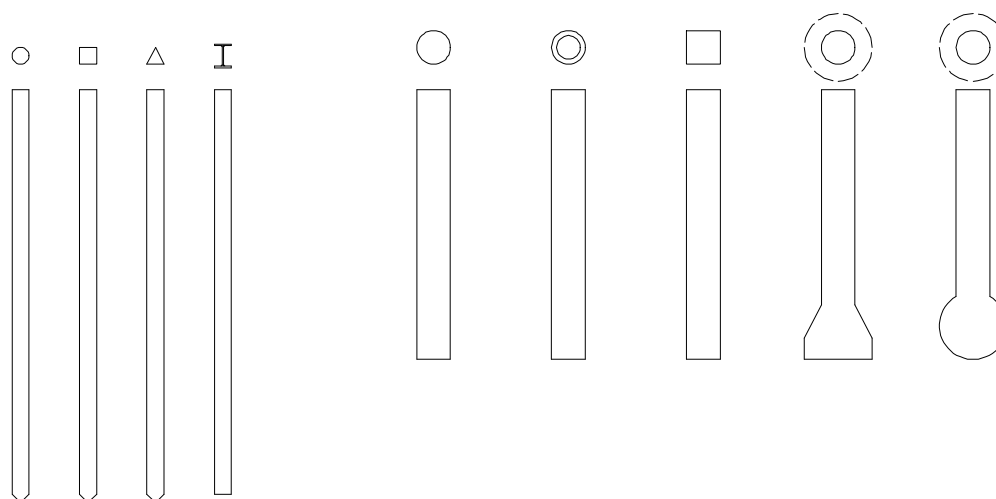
CONFIGURACIONES TÍPICAS EN CIMENTACIONES PROFUNDAS, PILOTES Y PILAS
